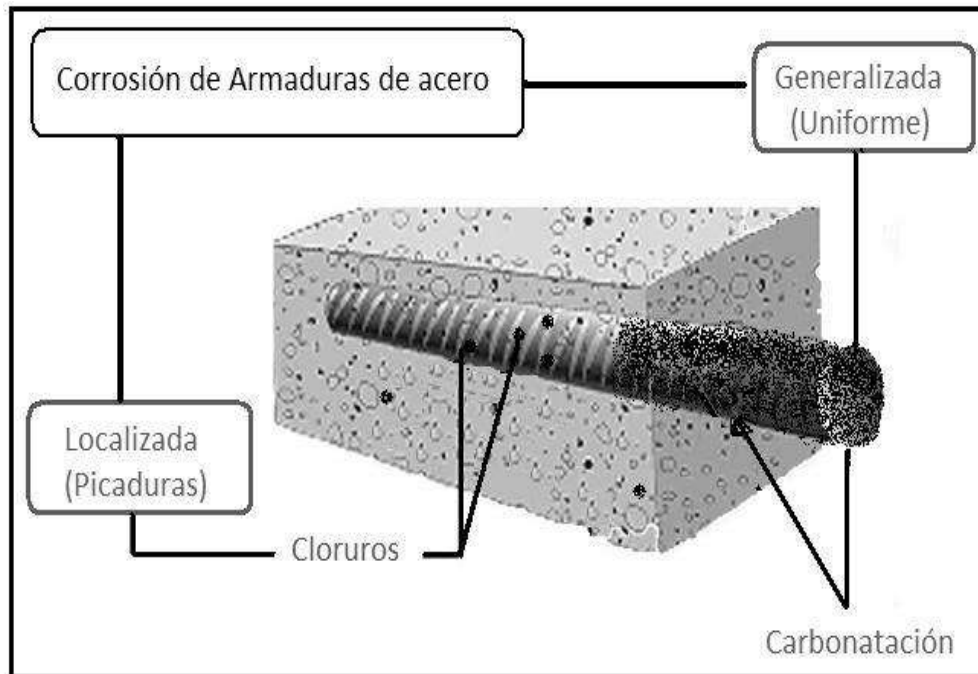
Tipos de ataque de corrosión en las armaduras de concreto. Fuente: (Paredes Cárdenas, 2016)
